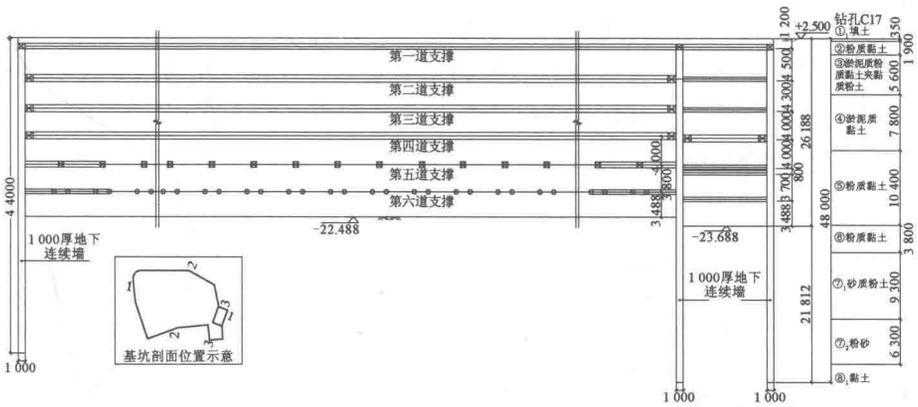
60 号地块基坑支护结构剖面图（尺寸单位：mm；高程单位：m）
